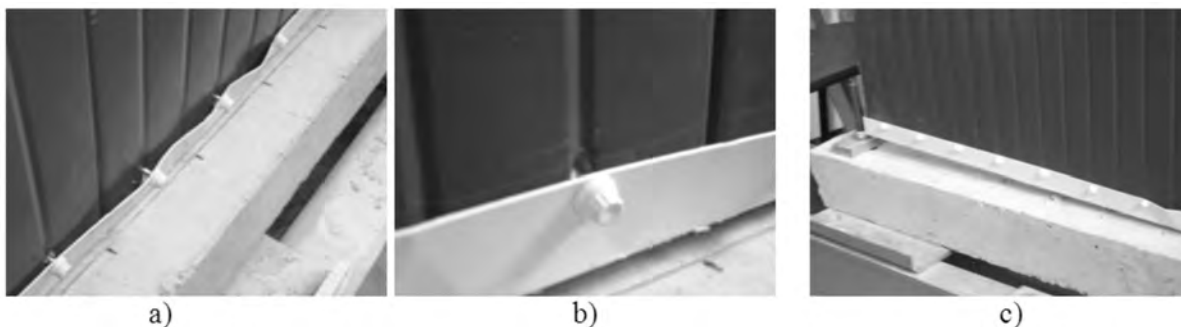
Detalles de la falla del muro con anclajes cada 145 mm: a) Desplazamientos inducidos por el muro al remate en “U”. b) Inicios de desgarramiento de las láminas colaborantes en los extremos del muro y en su zona central. c) Levantamiento total del remate con el muro al finalizar la prueba.
